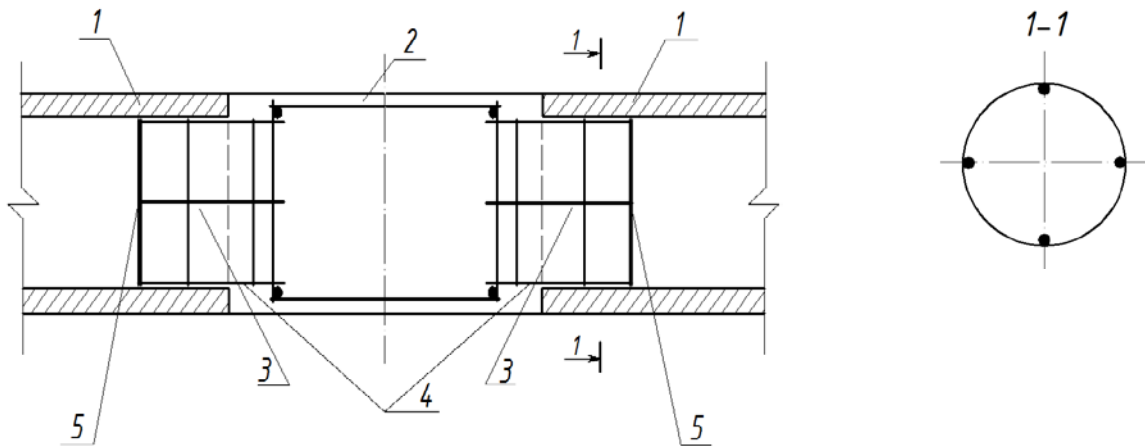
Удосконалений вузол з'єднання багатопустотних плит із монолітним ригелем перекриття [384]:
